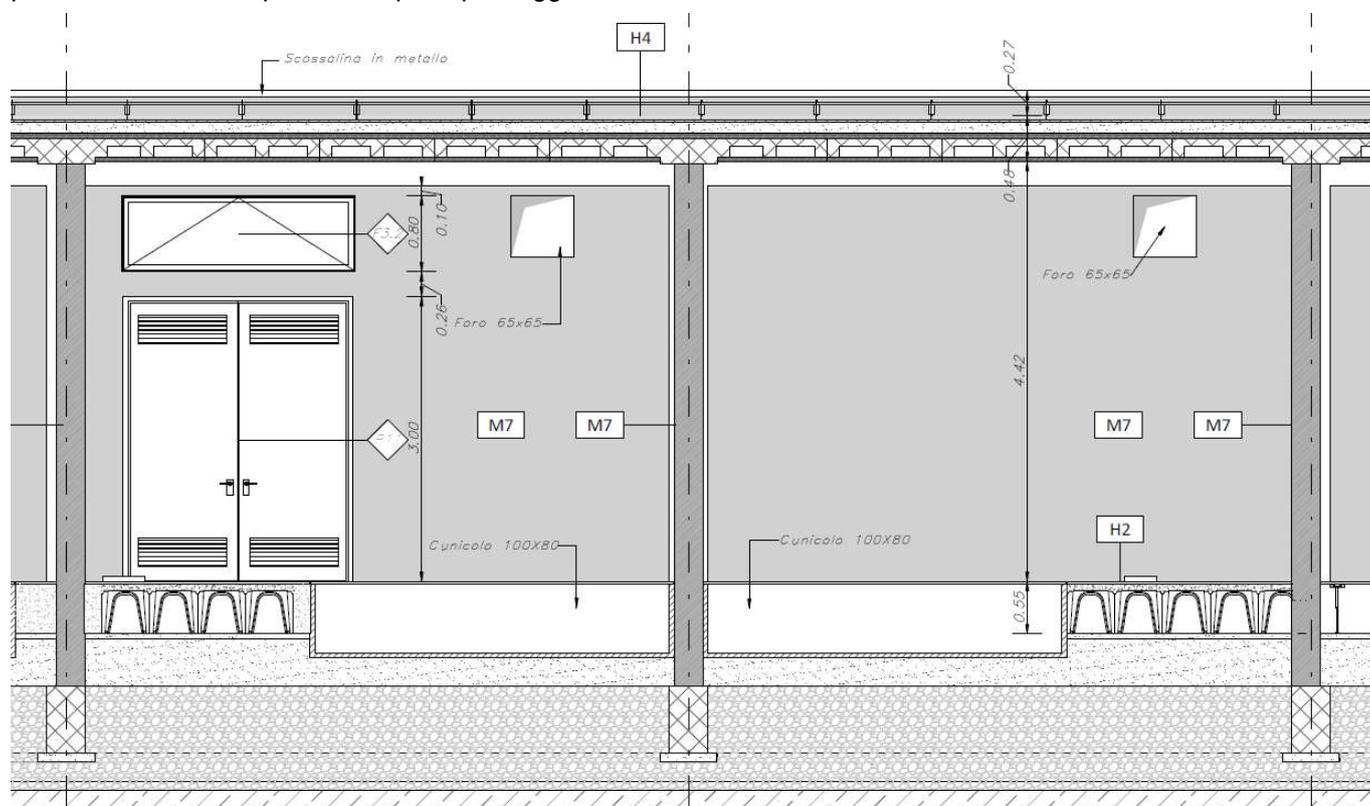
Dettaglio sezione cunicoli impiantistici e pavimento con igloo
